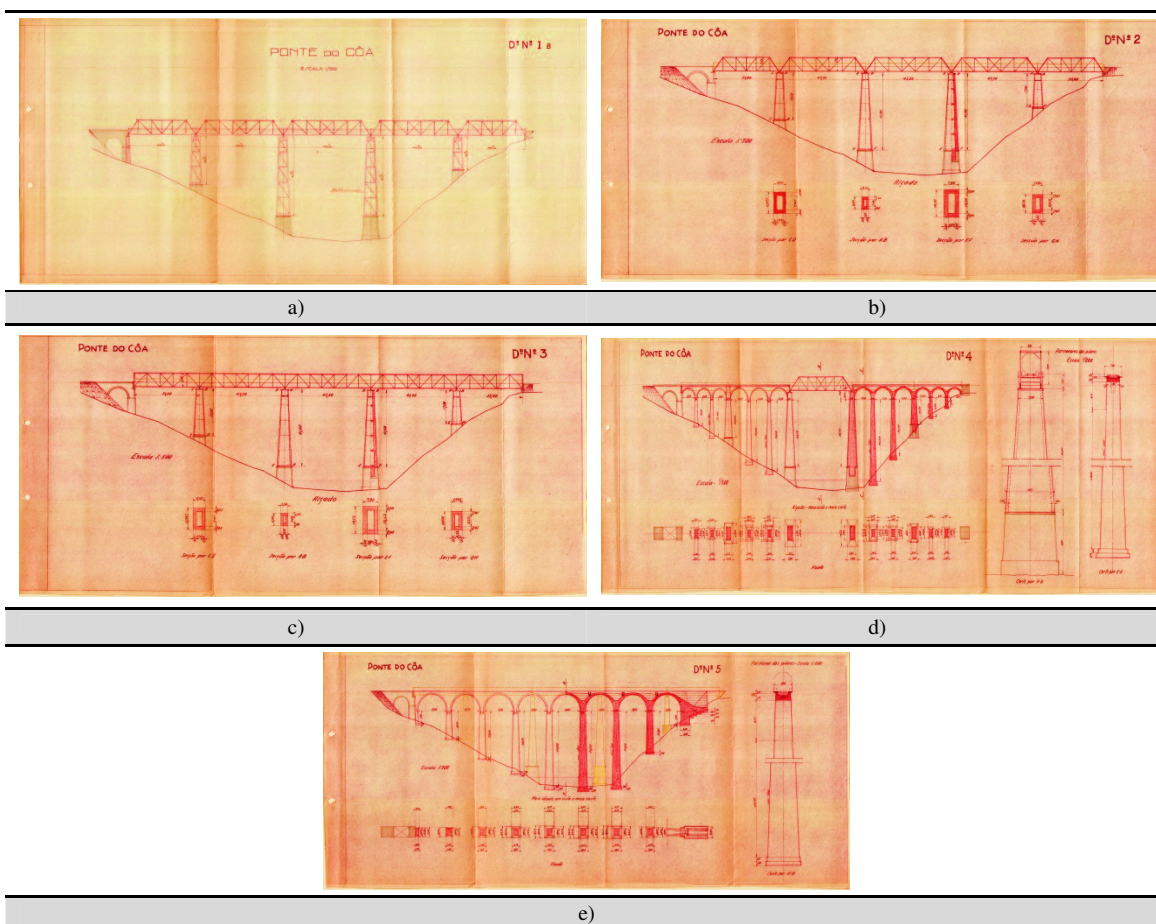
Propostas de construção da nova ponte do Côa na localização inicial
